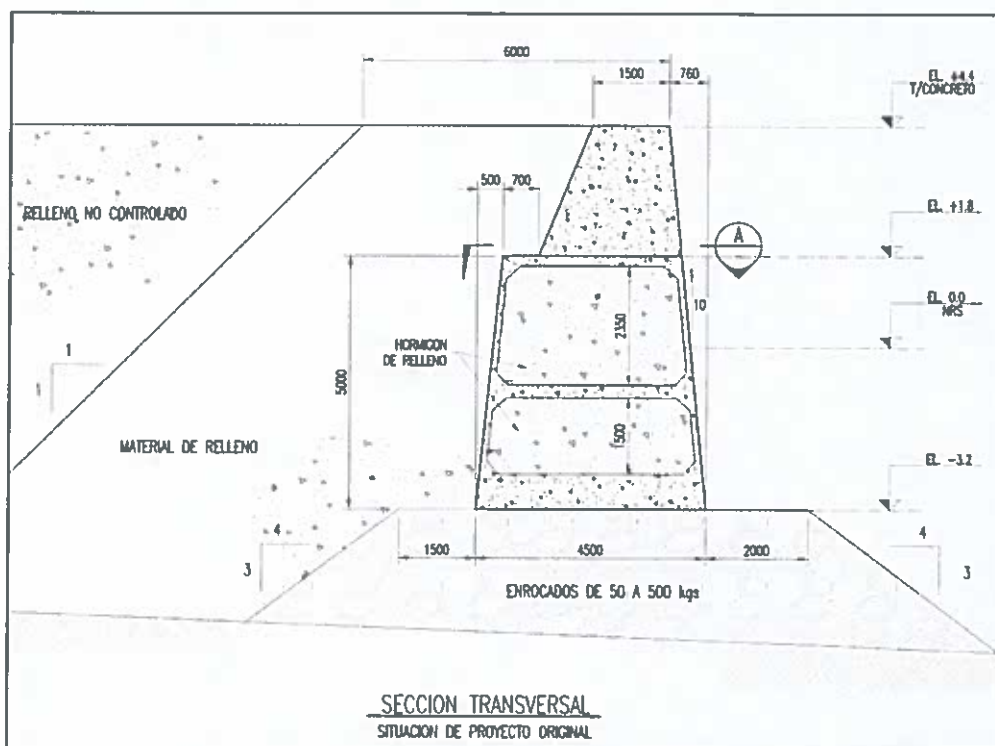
Sección transversal de muros Sitio N° 1 del Puerto de Arica, en Situación Original
